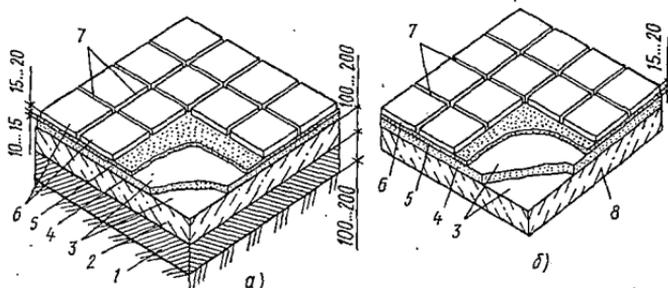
Щелочестойкие полы, уложенные на грунте (а) и на междуэтажном перекрытии (б):
